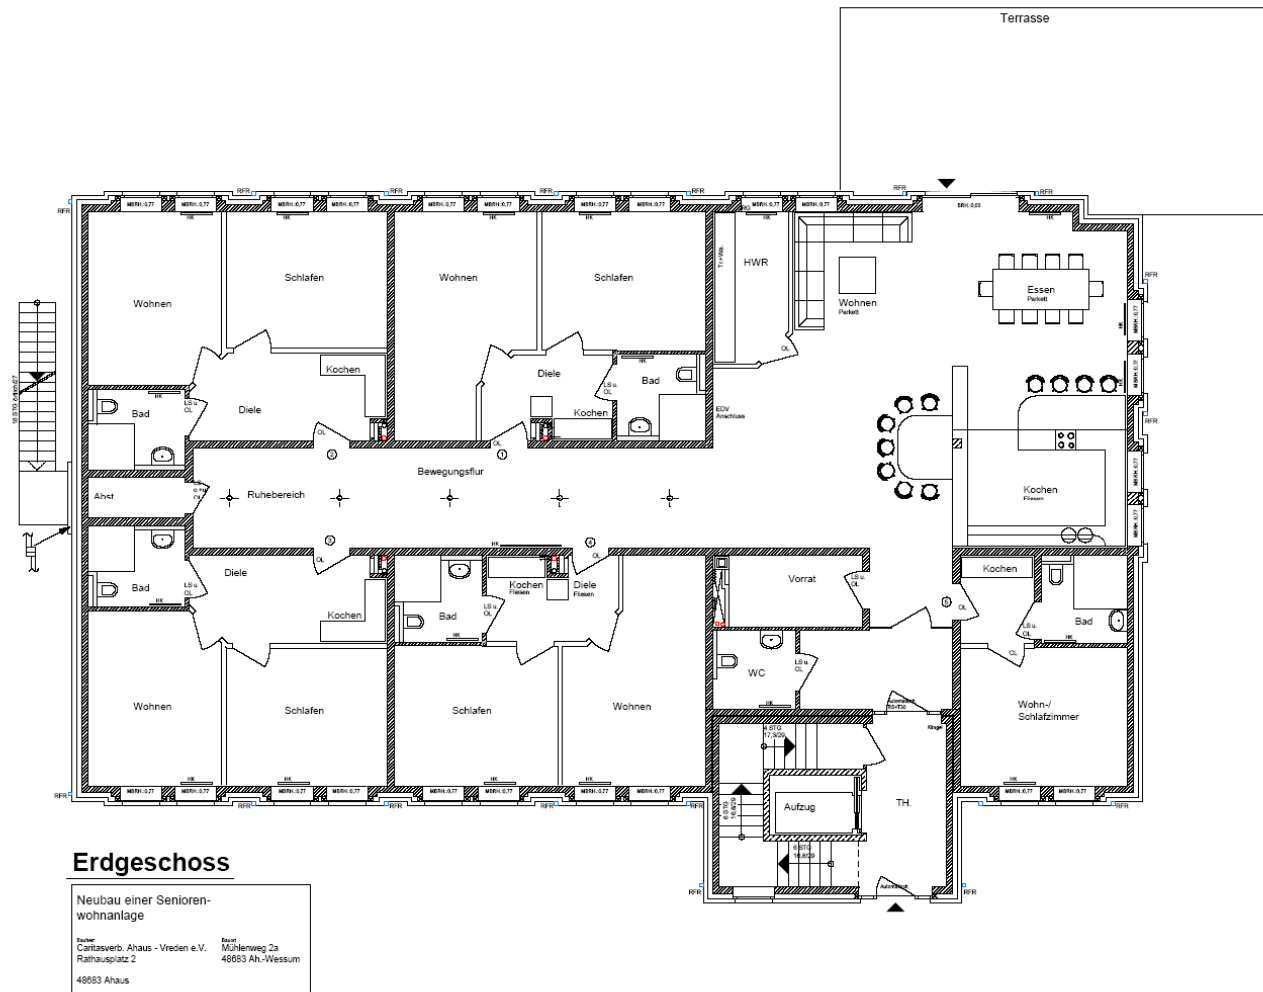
Grundriss Haus St. Martin Ahaus
